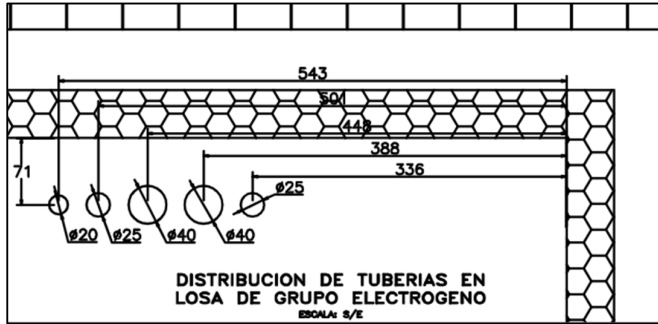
Detalle de tubería en Losa Maciza de Grupo Electrónico
